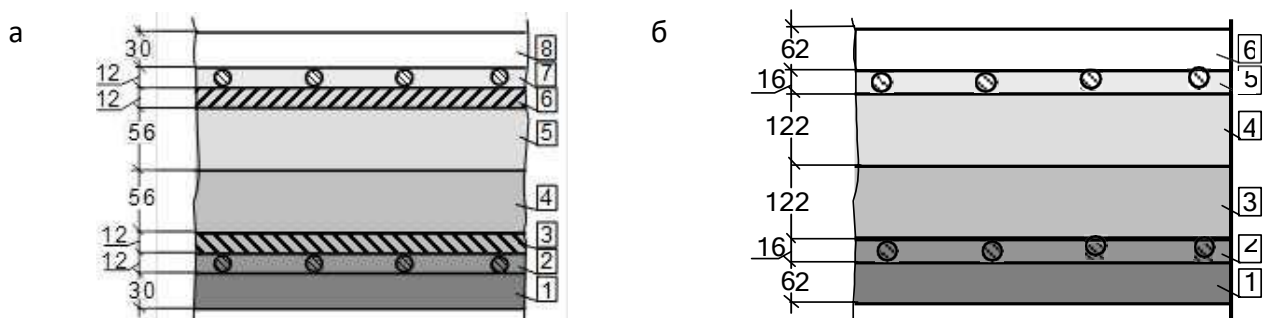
Розташування композитних шарів у планарних елементах для моделювання каркаса будівлі: а – перекриття; б – колонна
